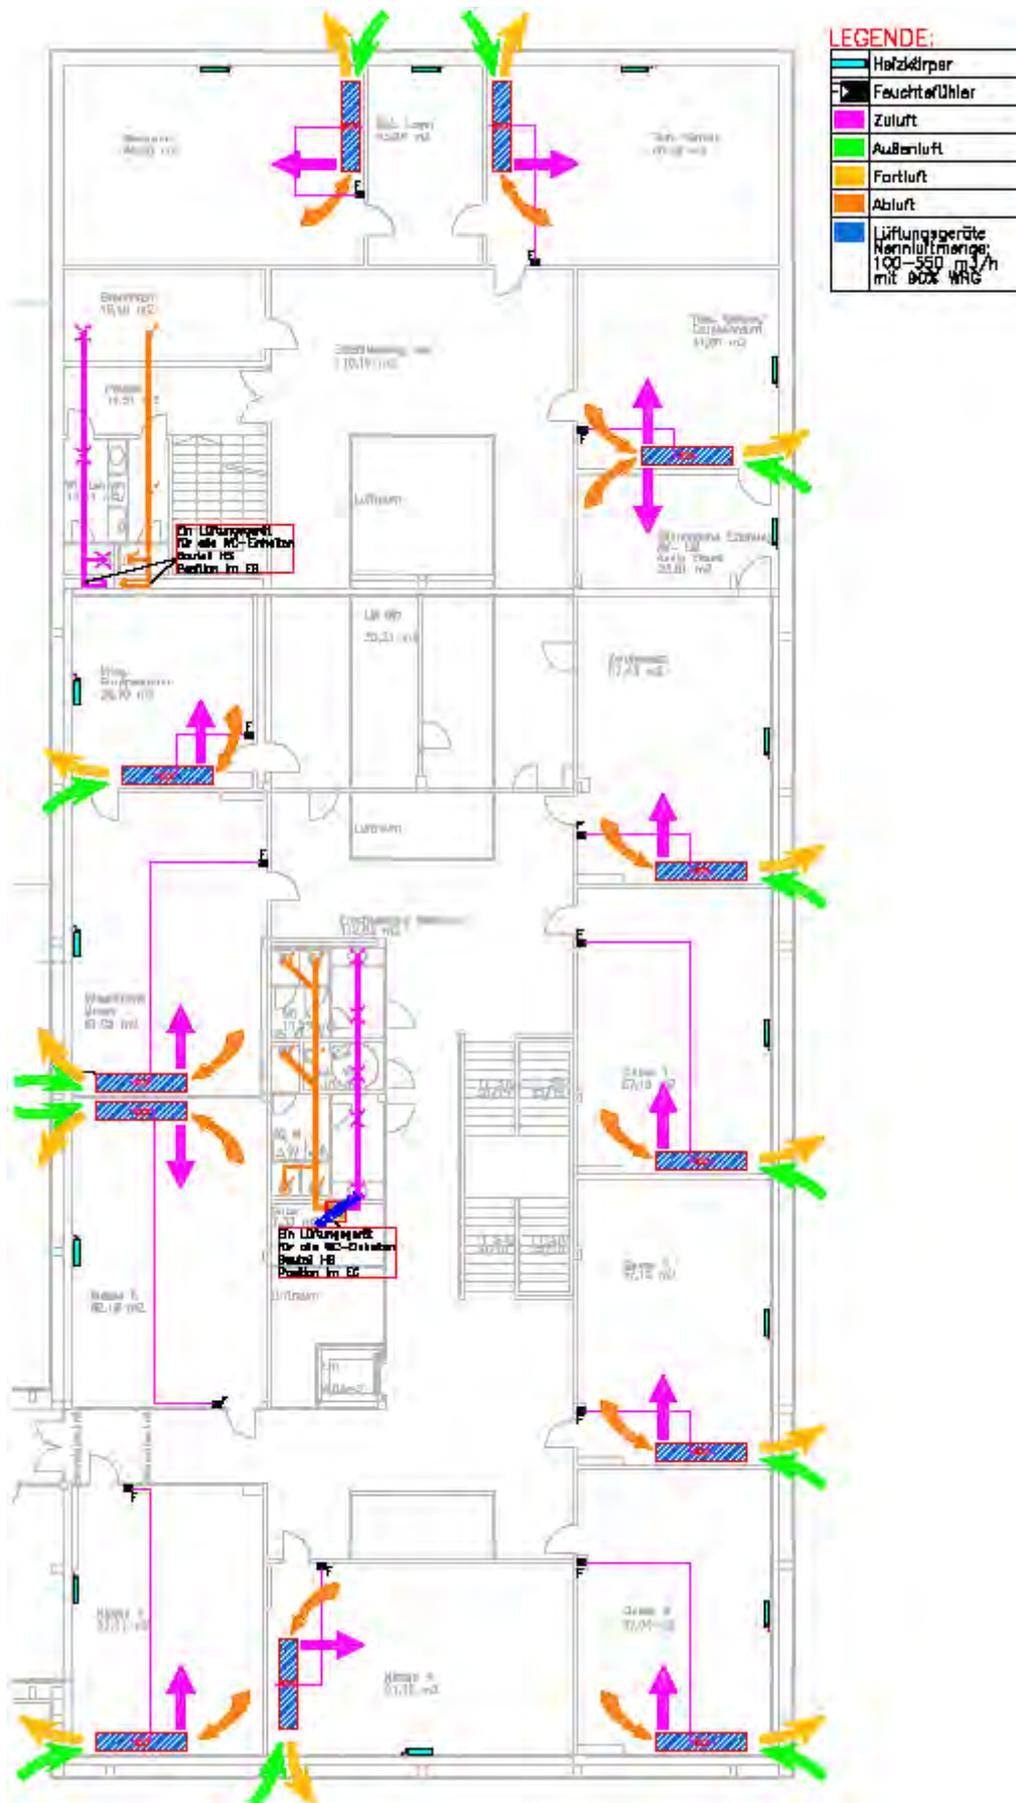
Prinzipdarstellung dezentrale Lüftung Grundriss HS 2 OG
